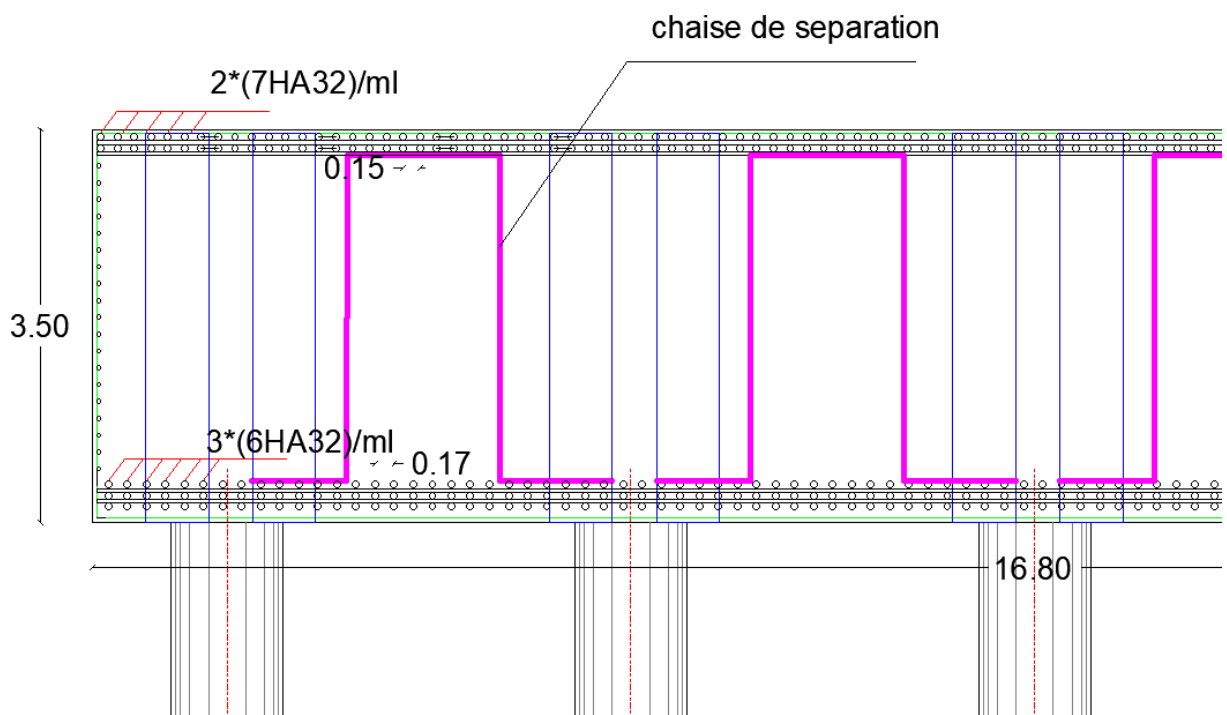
Schéma détaillé de ferrailage de semelle.
